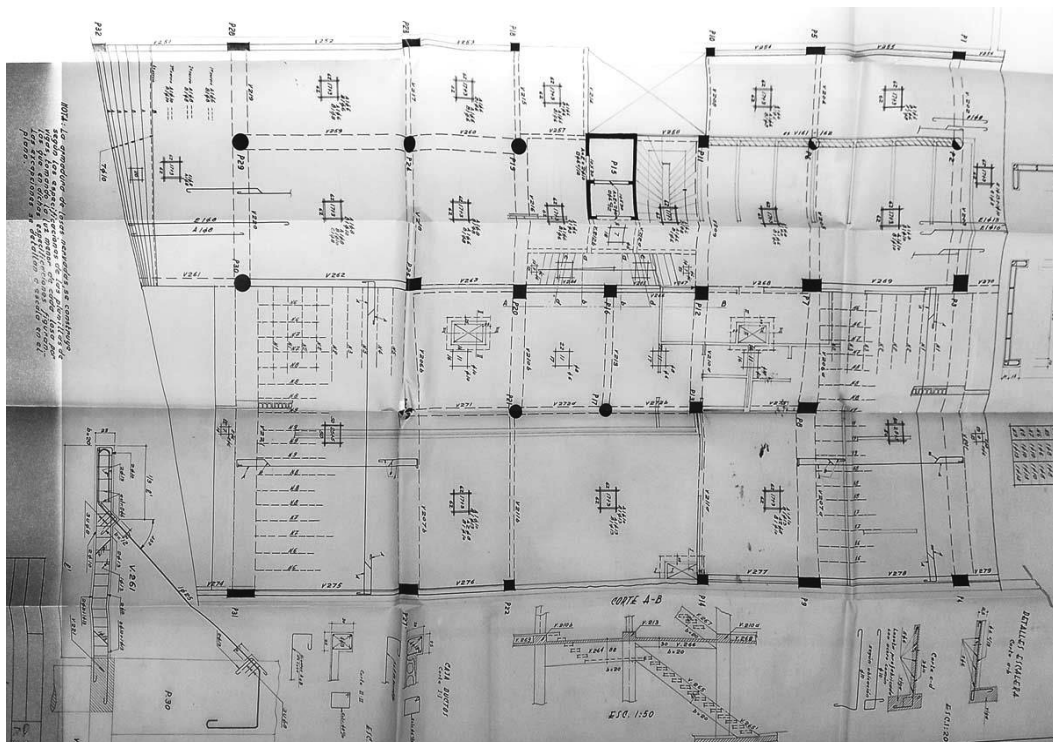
Estructura sobre Planta Baja, edificio Gilpe. Fuente: Centro de Documentación del Instituto de Historia, FADU, Udelar.
